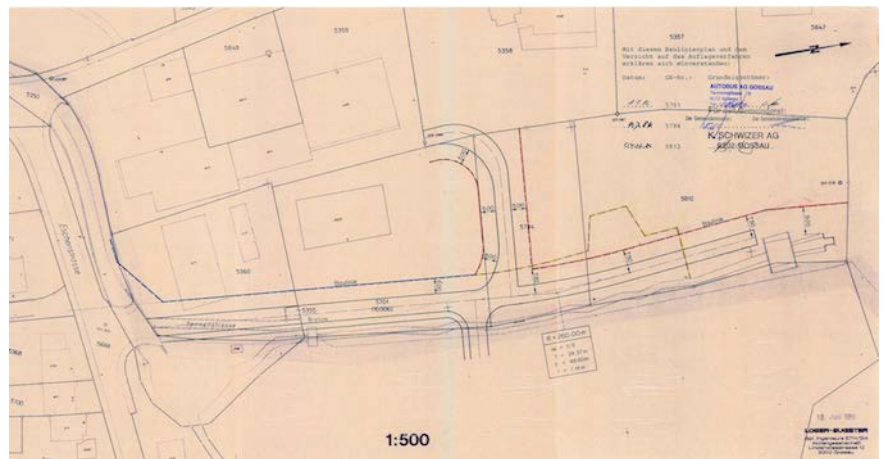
Überbauungsplan Andwilerstrasse 28 – 42 (ohne Massstab)
